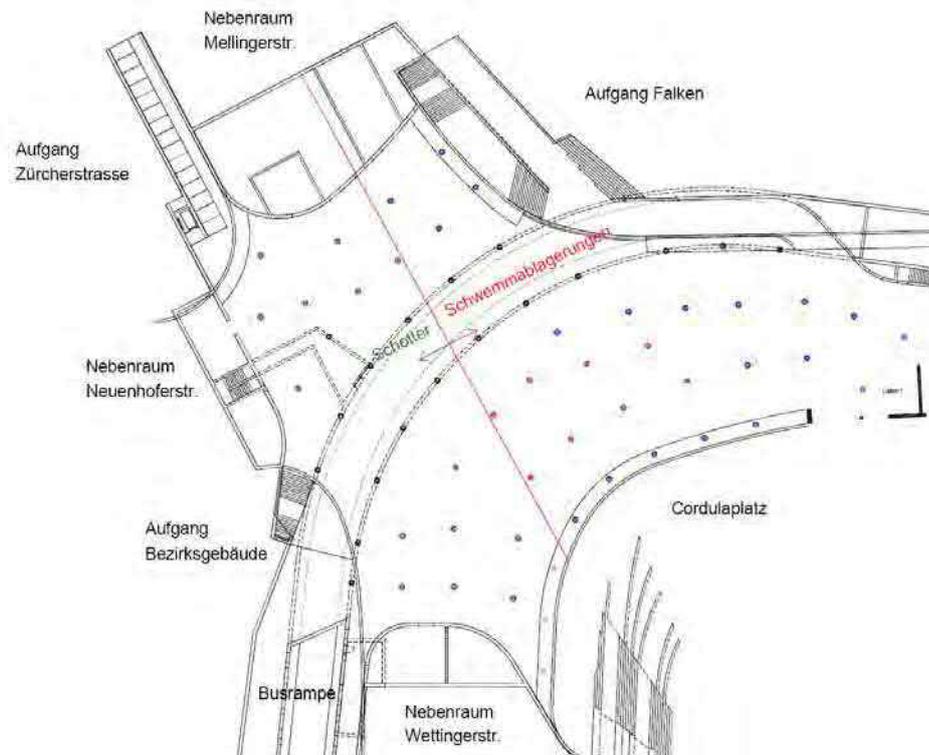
Stützeinteilung aufgrund Lastklasse und Baugrund
